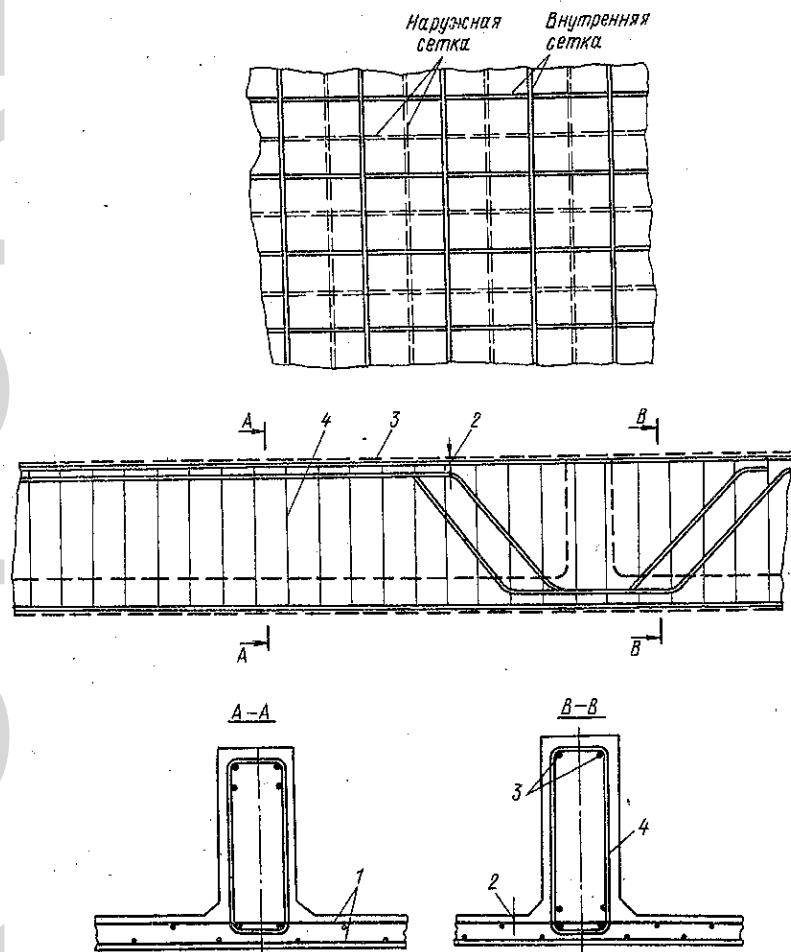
Схема армирования плит обшивки и балок набора железобетонных судов
